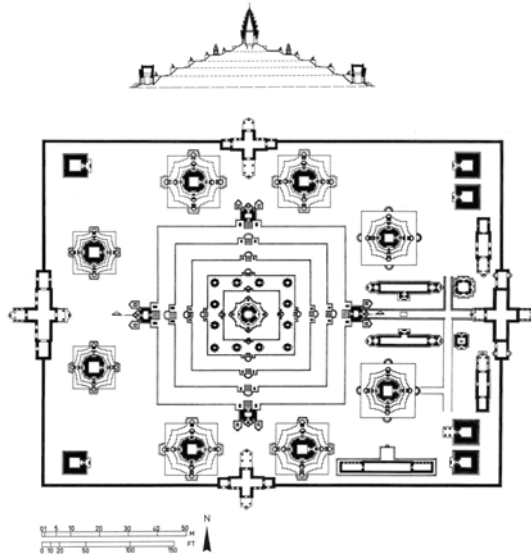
Grundriss/Schnitt Bakong/Rolous
